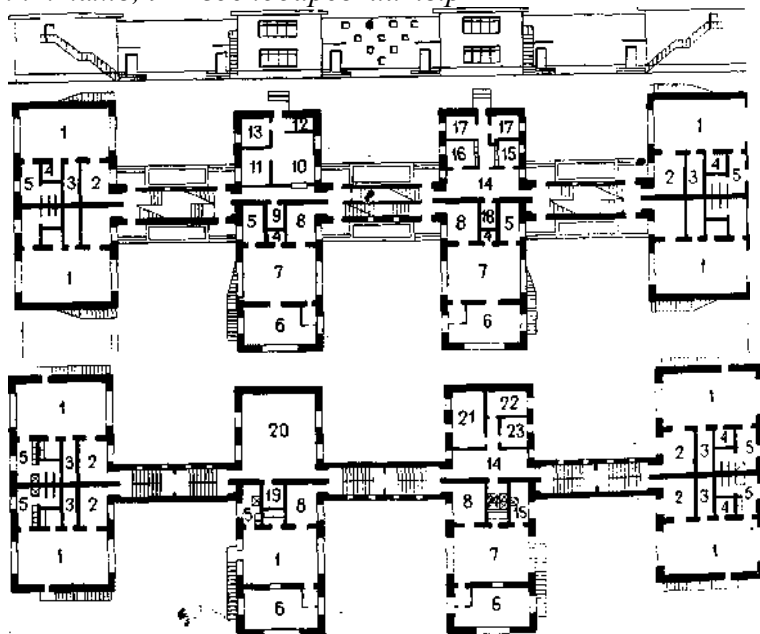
Будівля ясел - саду на 280 місць в мікрорайоні В-23 житлового району Чиланзар в Ташкенті. Фасад і плани першого і четвертого поверхів: 1 — групова; 2 — роздягальня; 3 — спальня; 4 — буфетна; 5 — туалетна; 6 — веранда; 7 — їдальня - гральна; 8 — приймальня; 9 — електрощитова; 10 — кухня; 11 — заготівка; 12 — комора овочів; 13 — комора сухих продуктів; 14 — хол; 15 — кабінет завідуючої; 16 — мед кімната; 17 — палата; 18 — туалетна для персоналу; 19 — комора інвентарю; 20 — кімната для музичних занять; 21 — кімната персоналу; 22 — господарська комора; 23 — комора чистої білизни; 24 — душова для персоналу
